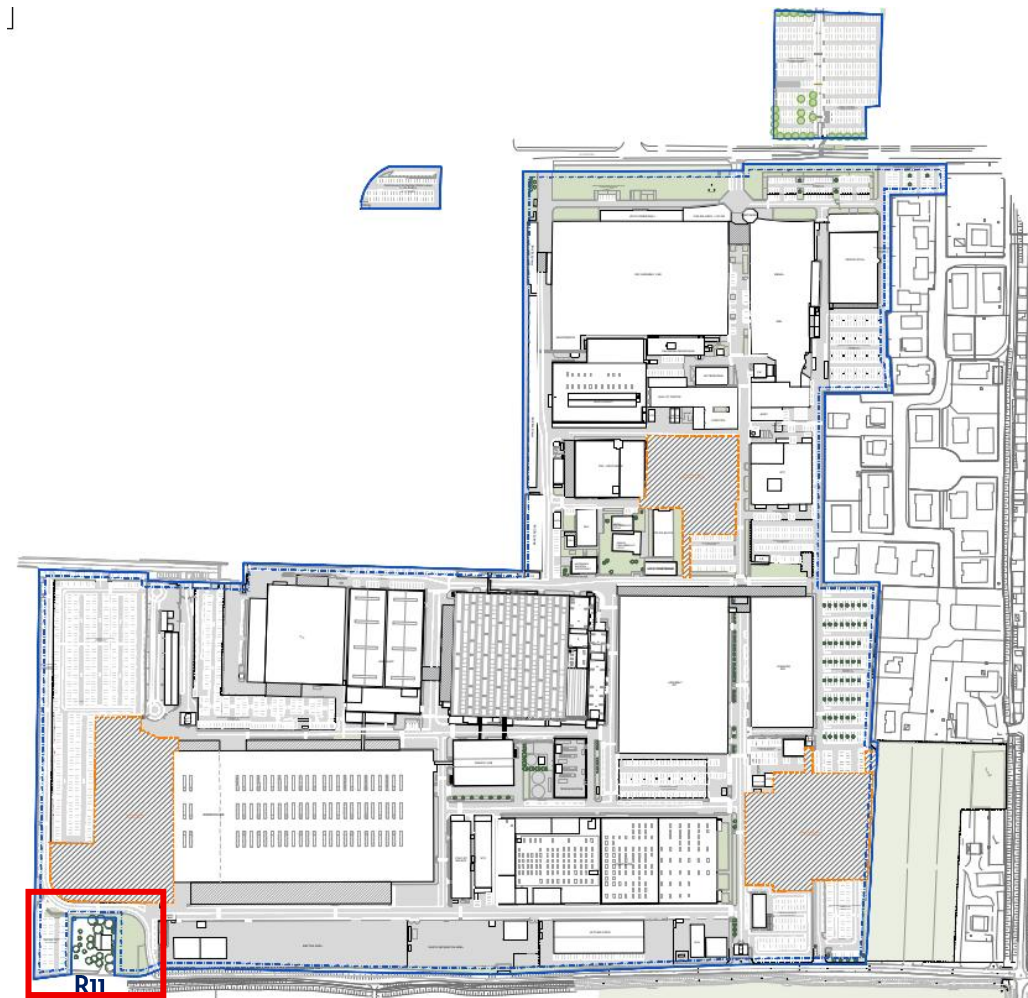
Planimetria generale As-is con individuazione del recettore R11
